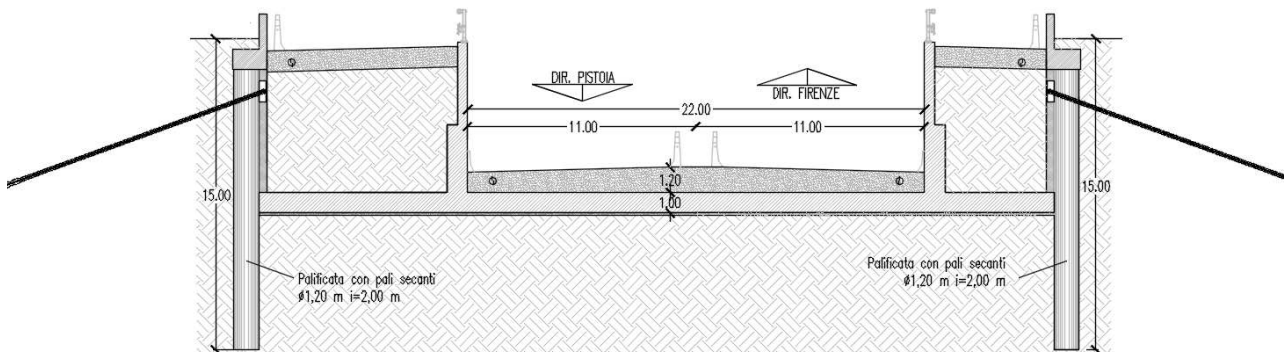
Sezione tipica con paratia tirantata nella zona con rampe lato via Nenni
